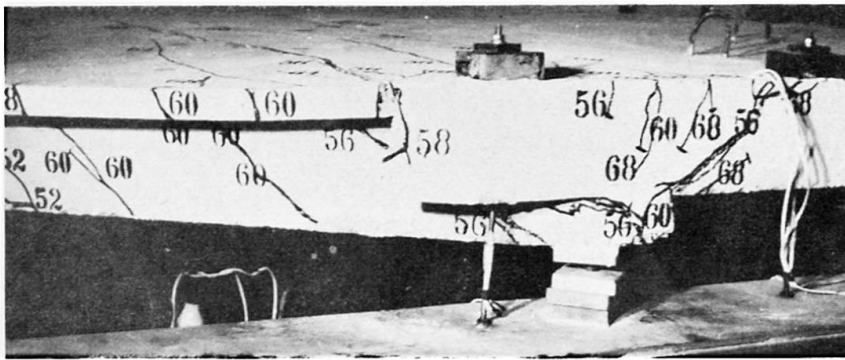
Der Verlauf der Risse im stumpfen Ecke des Stahlbetonmodells der Platten-Balkenbrücke.
